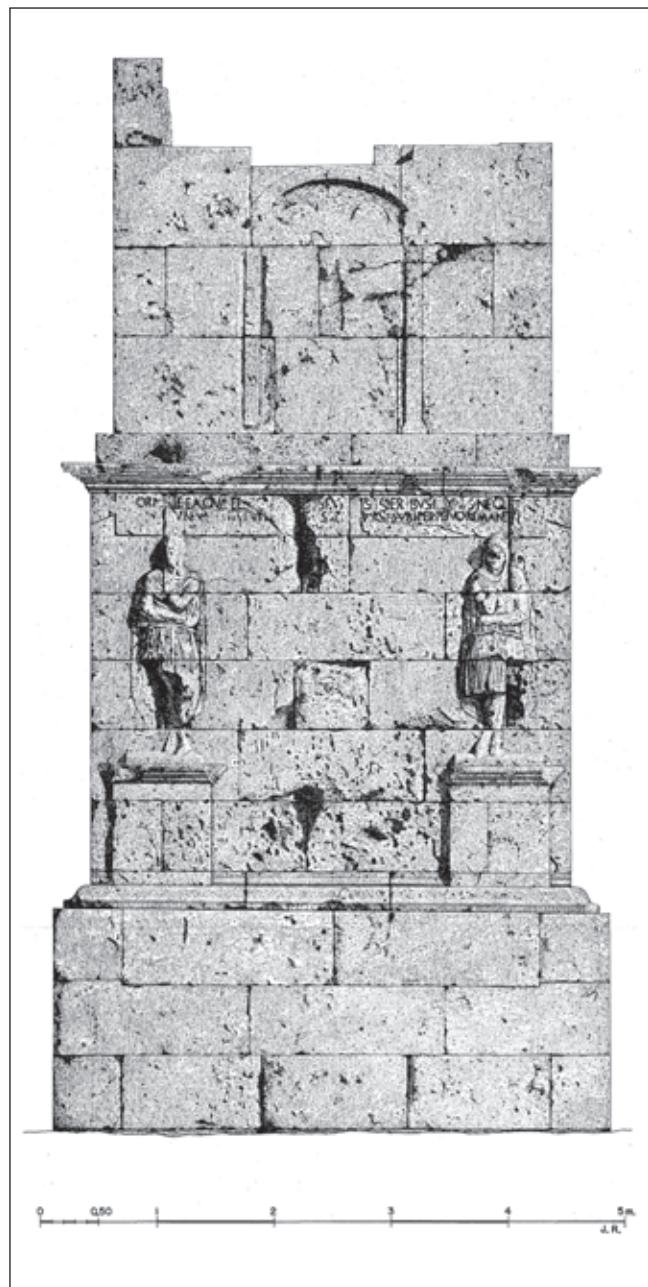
Alzado frontal de la Torre de Hauschild, Mariner y Niemeyer (1966).
